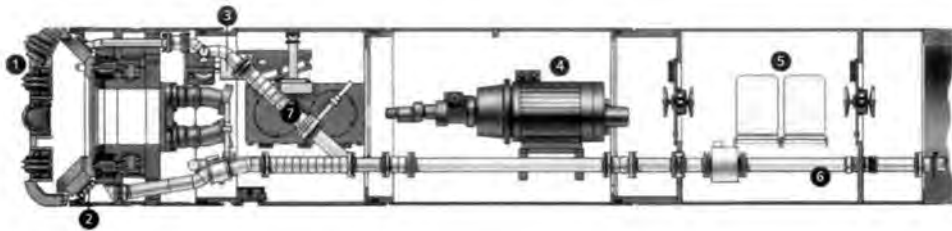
Schéma mikrotunelování s hydraulickou dopravou zemín.
